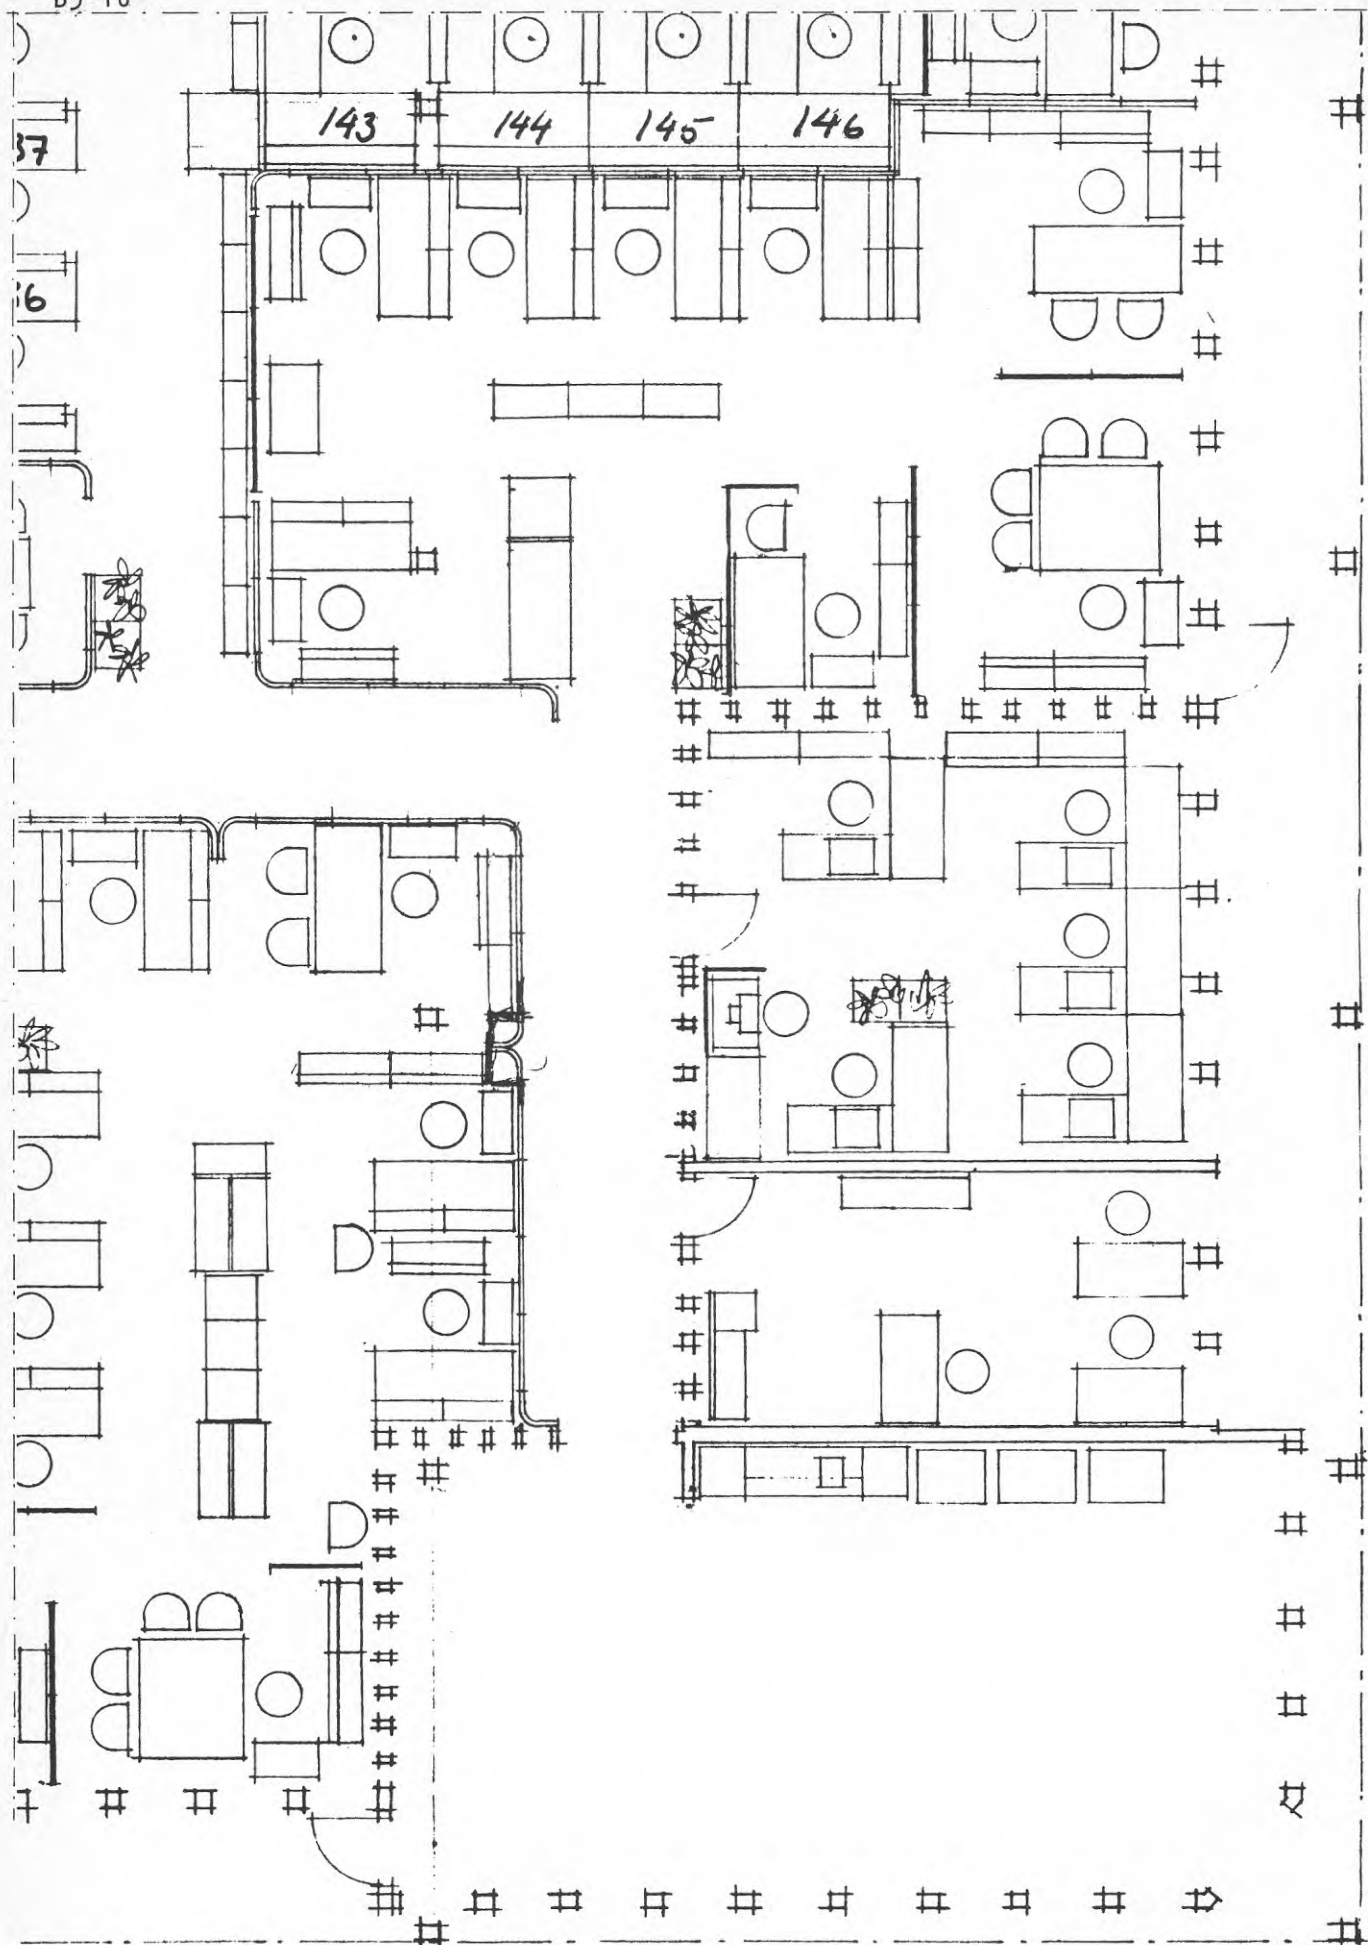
Plan med layout, del av ritning 1975-10-13
